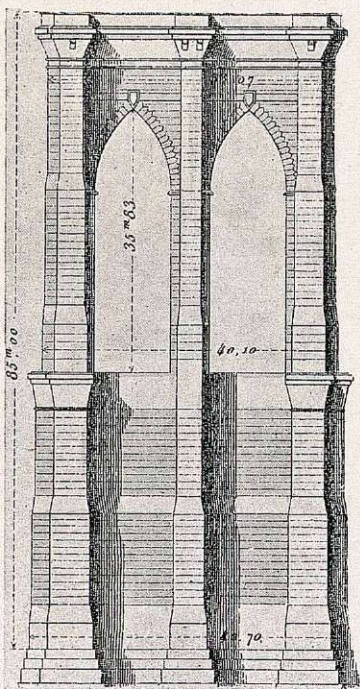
Alzado transversal del puente de Brooklyn (1867).
